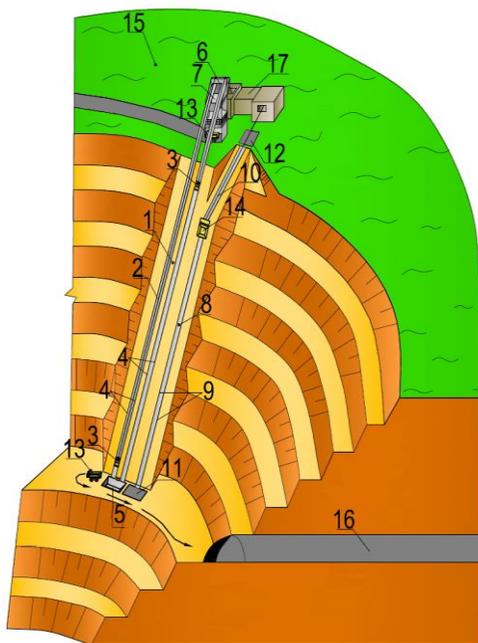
Конструкция карьерного подъемника: 1 – карьерный подъемник; 2 – тяговая часть подъемника; 3 – транспортируемая горная масса; 4 – трасса подъемника; 5 – погрузочный бункер; 6 – разгрузочная башня; 7 – разгрузочный бункер; 8 – подъемное устройство; 9 – направляющие для шахтного оборудования; 10 – стальной канат подъемного устройства; 11 – площадка приема и подачи оборудования на нерабочем борту карьера; 12 – площадка приема и подачи оборудования на поверхности; 13 – автосамосвал с породой из рудника; 14 – самоходное транспортное оборудование; 15 – поверхность; 16 – подземная выработка
